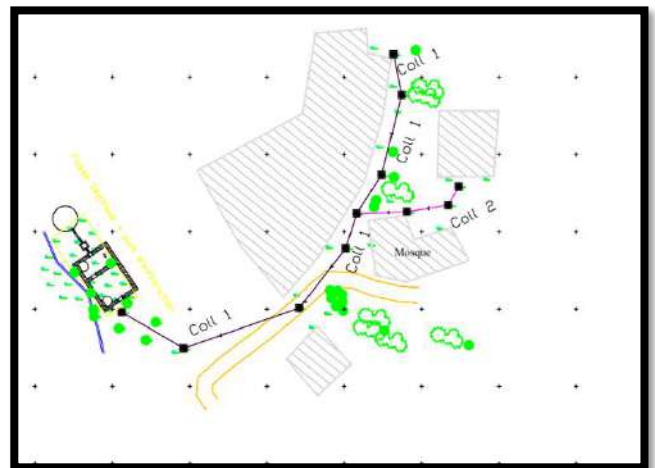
Vue en plan du réseau d'Imi N'Ouarguioun
